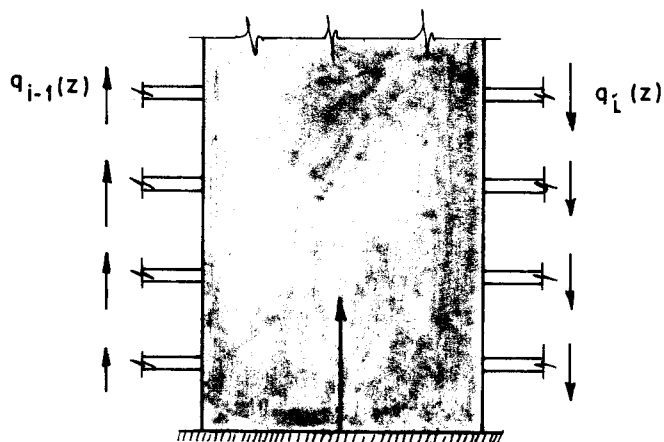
PAREDE i ISOLADA, EM ELEVÇÃO
